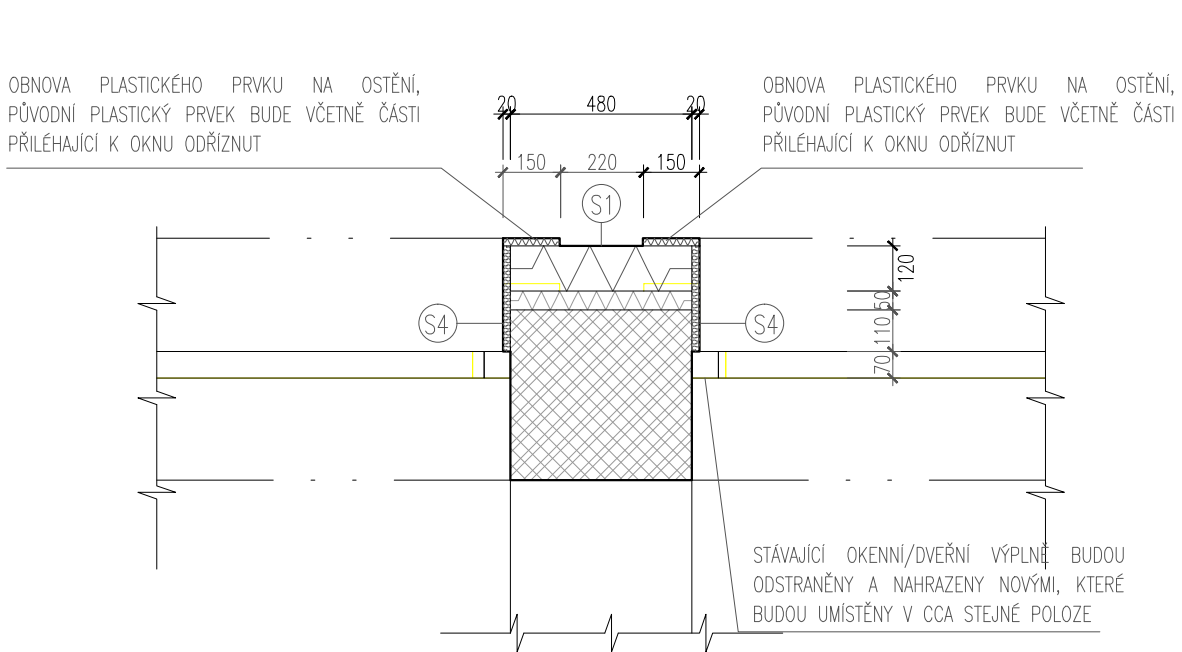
ŘEŠENÍ U ÚNIKOVÝCH DVEŘÍ VE 2.NP
